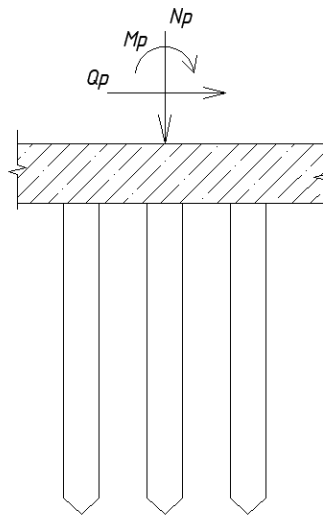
Схема приложения нагрузок на ростверк
